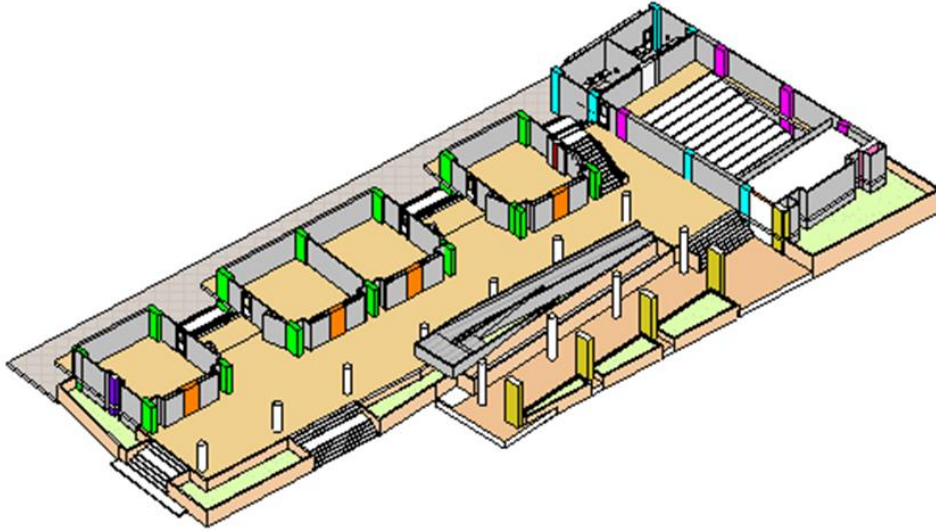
Vista Sección Arquitectónica planta N° 1.
